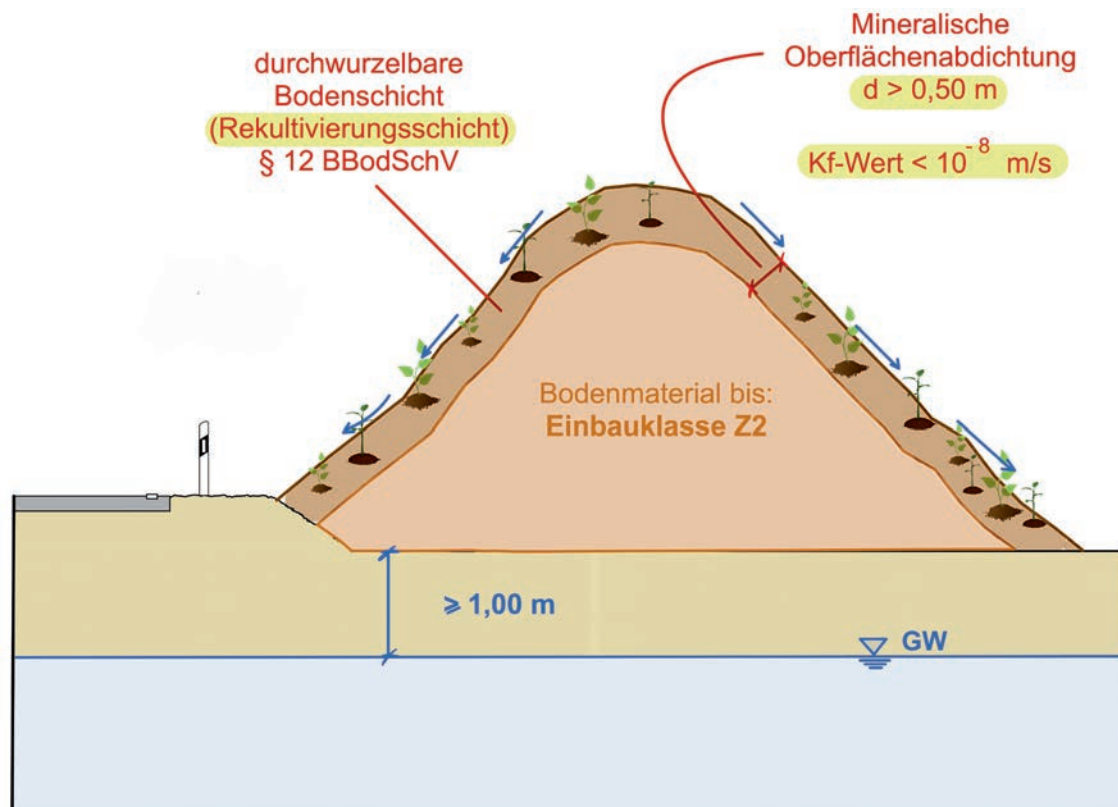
Z2 – Eingeschränkter Einbau mit Sicherungsmaßnahmen – Lärmschutzwall (Erdbaumaßnahme)
